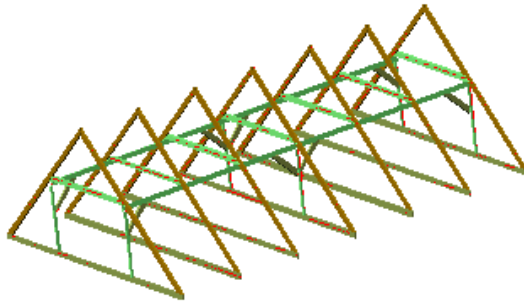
Przykładowa konstrukcja pławiowo-kleszczowa
